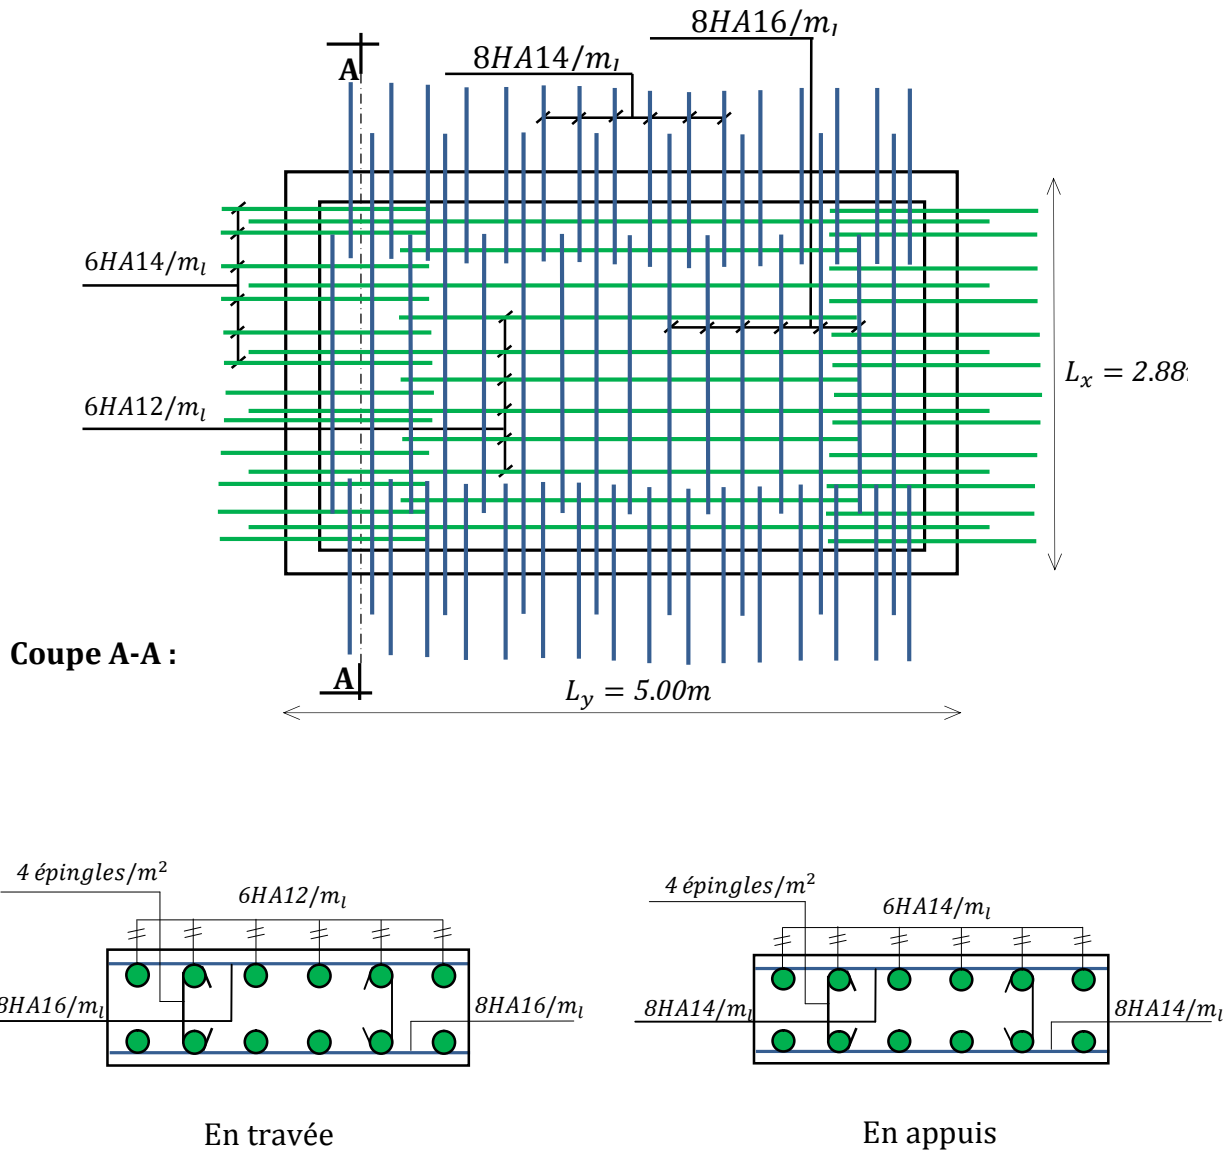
Schéma du ferrailage du mur adossé de 7.20m de hauteur.
